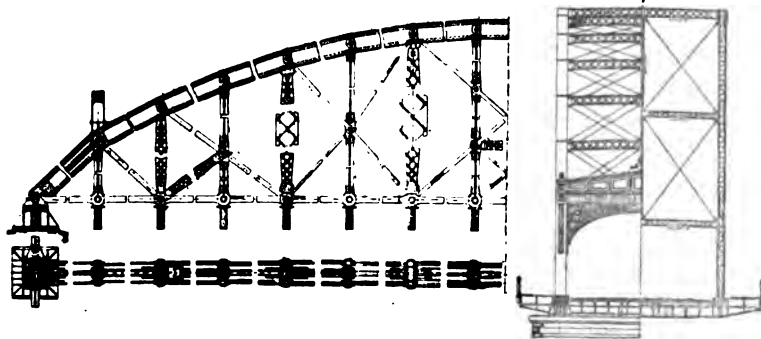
à 323. — Pont de la Sixième rue, à Pittsburg. Portée 133^m,97.
